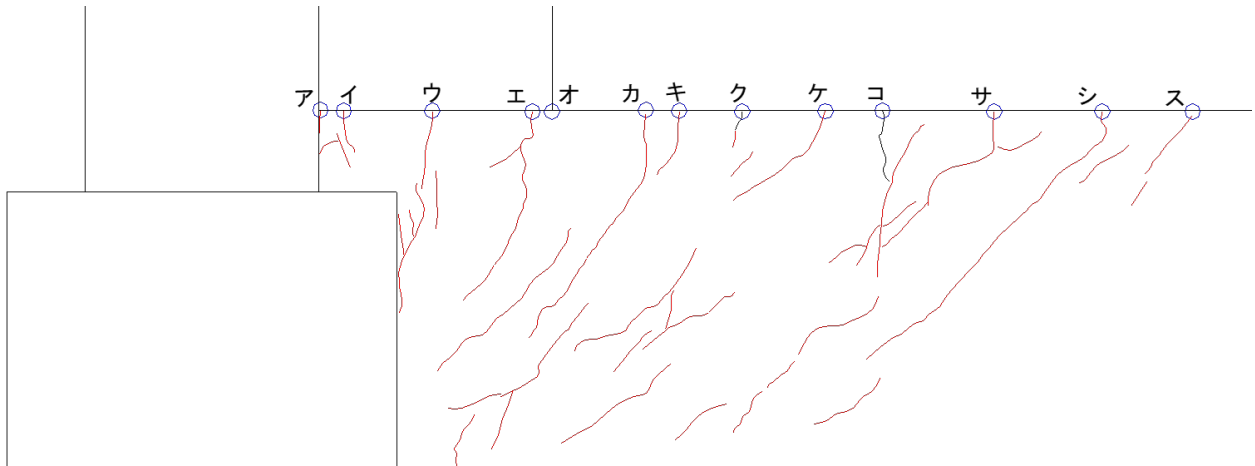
基礎梁ひび割れ幅測定位置(試験体 B-1 負載荷)
